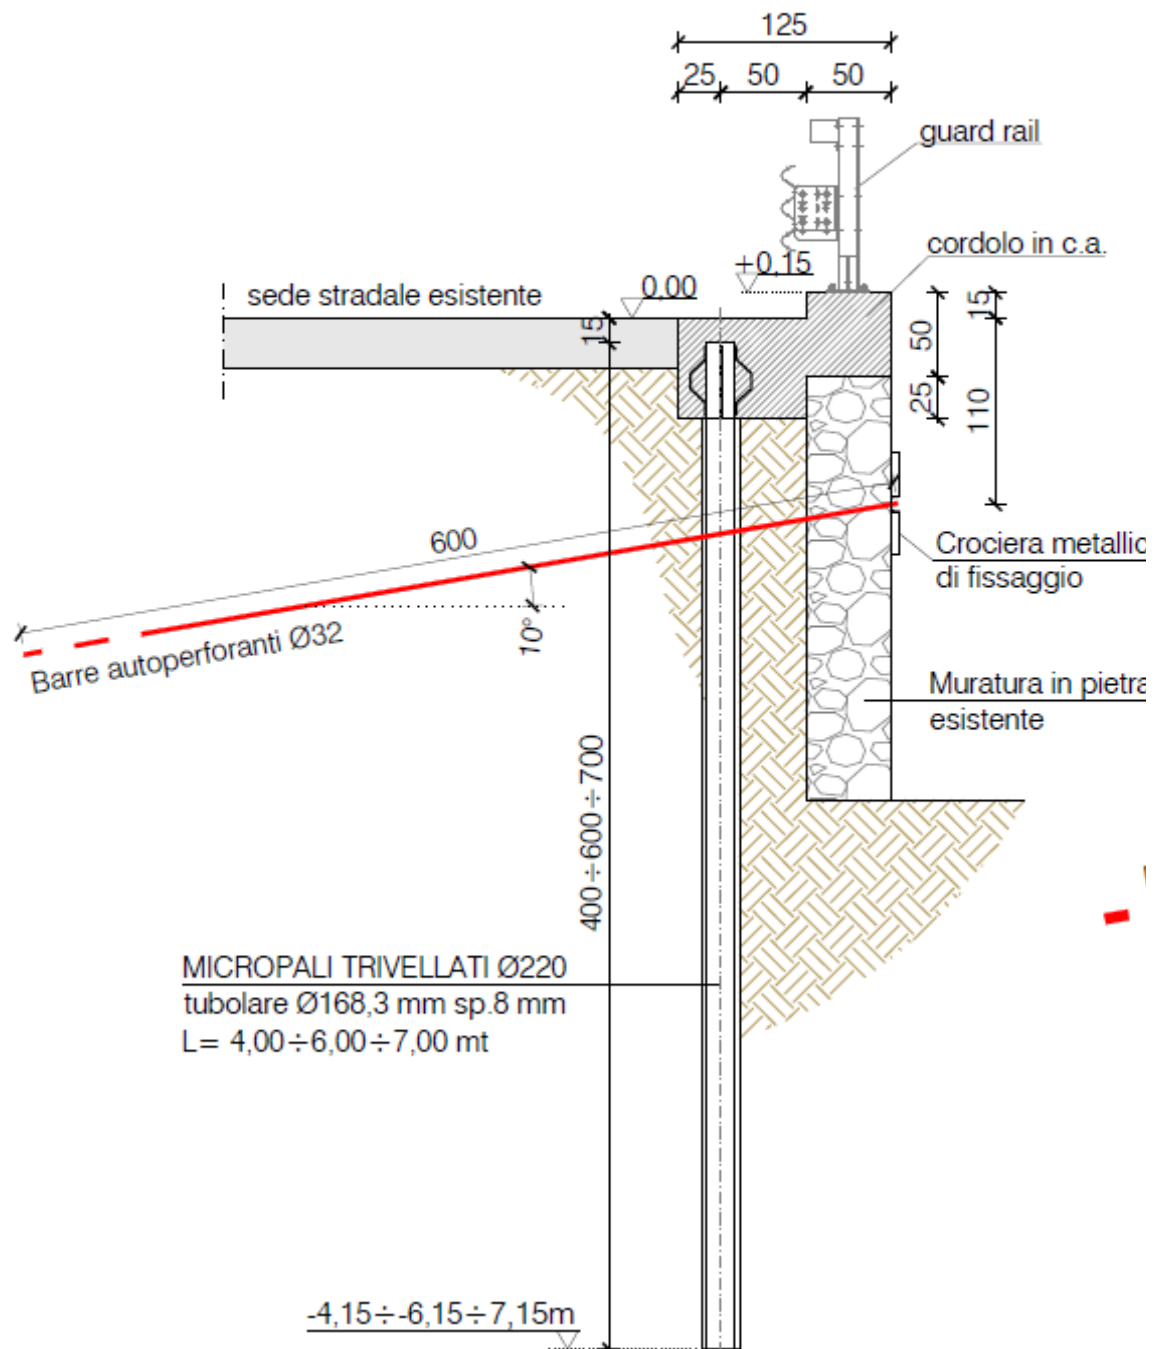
Sezione tipo dell'intervento di rinforzo del muro esistente.
